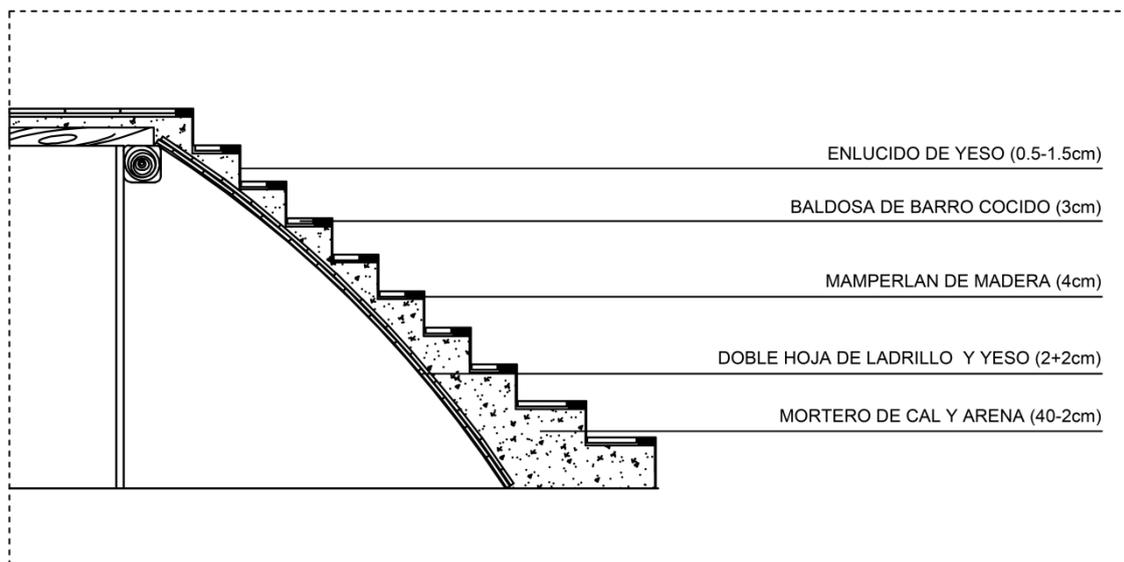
Detalle constructivo de la escalera con bóveda en sección
